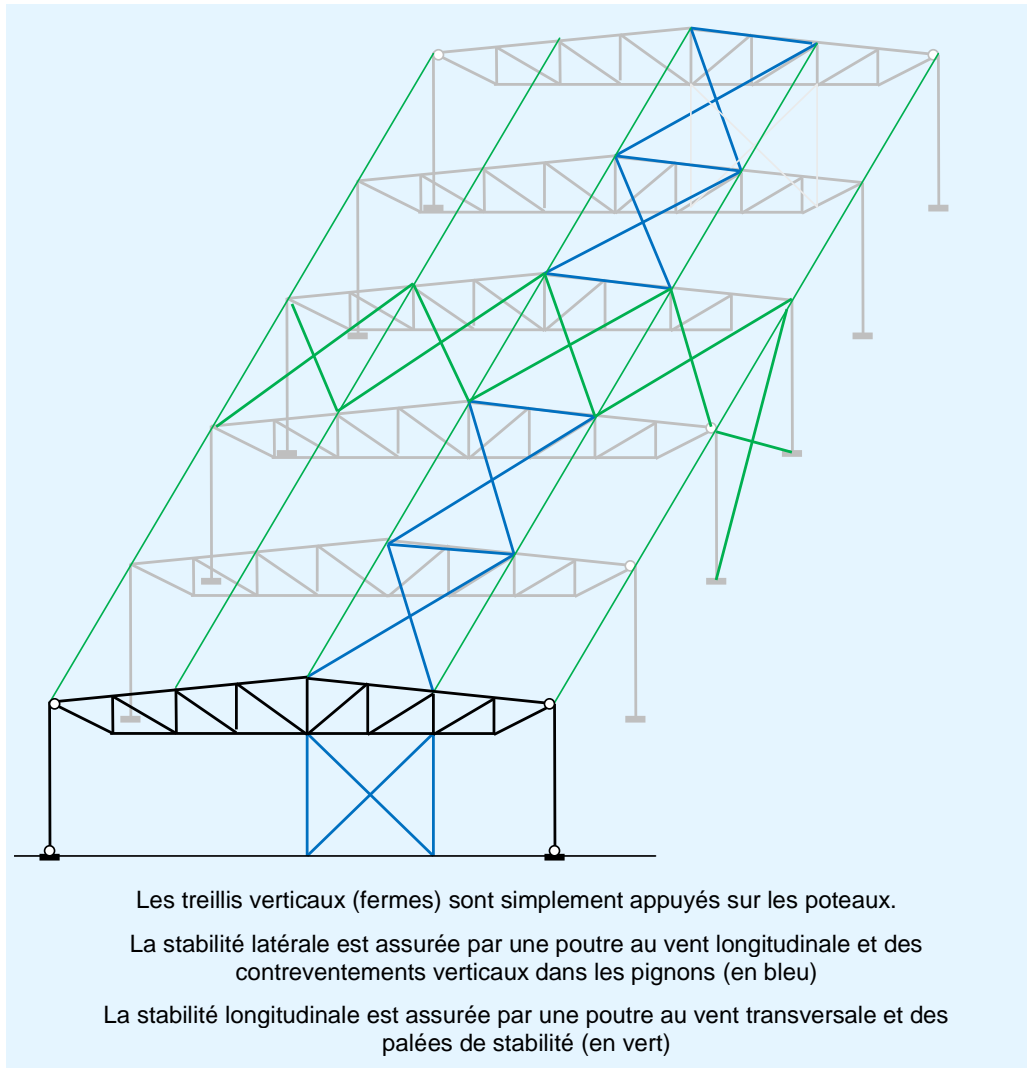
Disposition structurale à base de poutres et de poteaux
